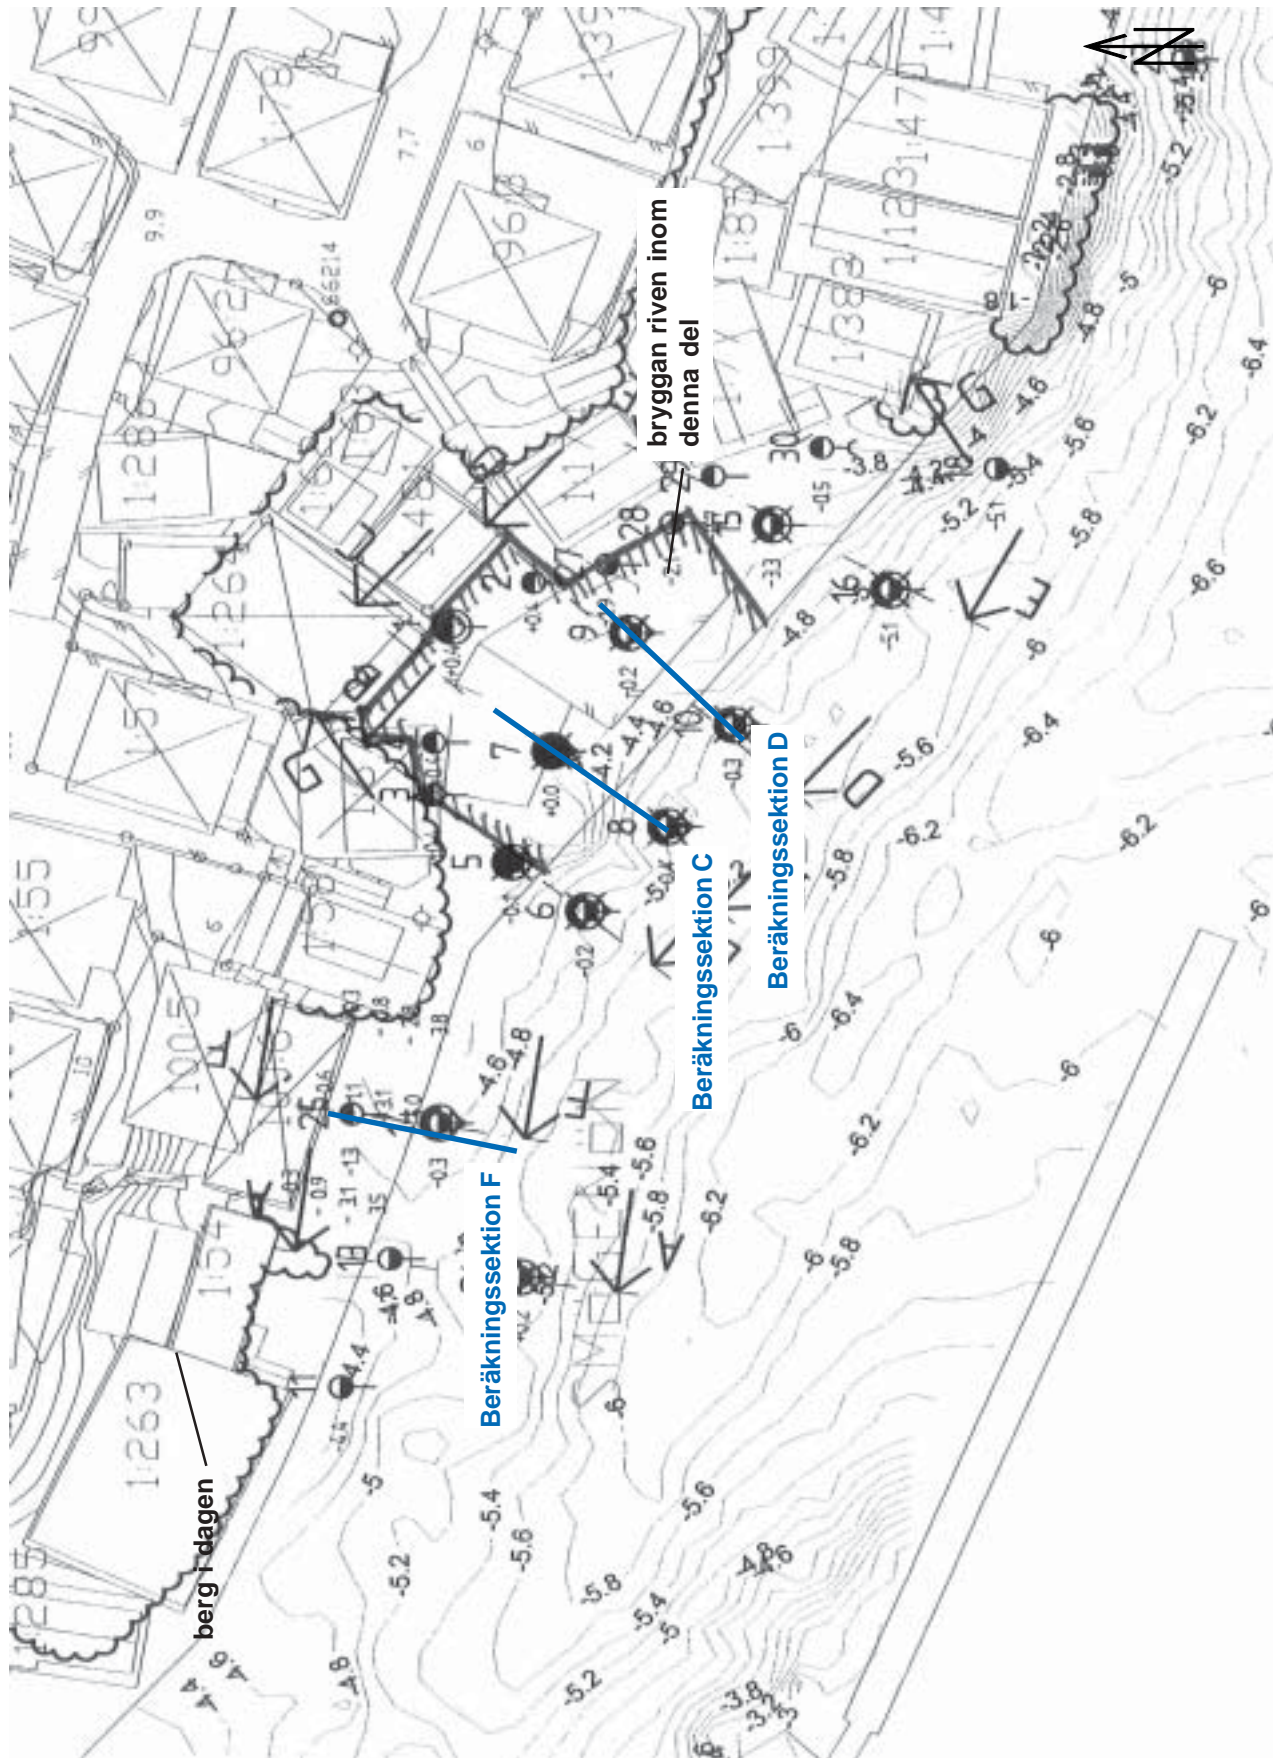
Plan, beräkningssektioner, undersökningspunkter mm
